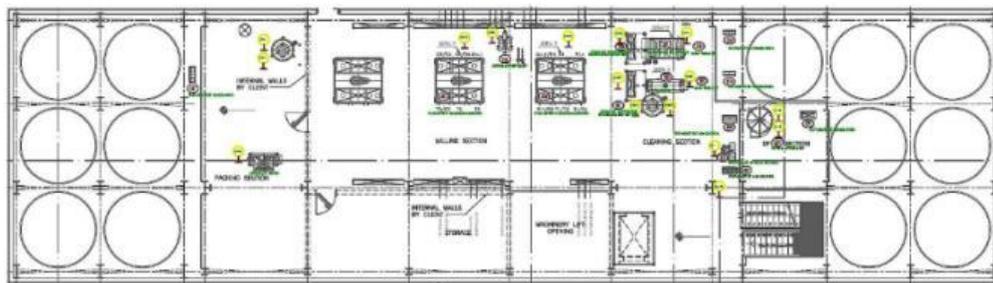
Plano tipo de un nivel de la Planta de Producción
